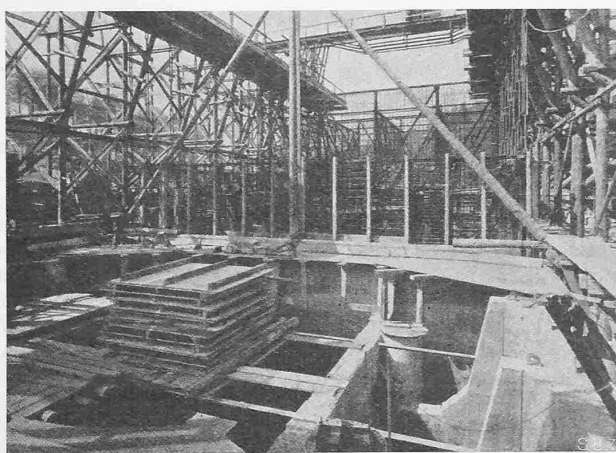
Caissons de la pile II pendant leur construction. 22 avril 1920.
